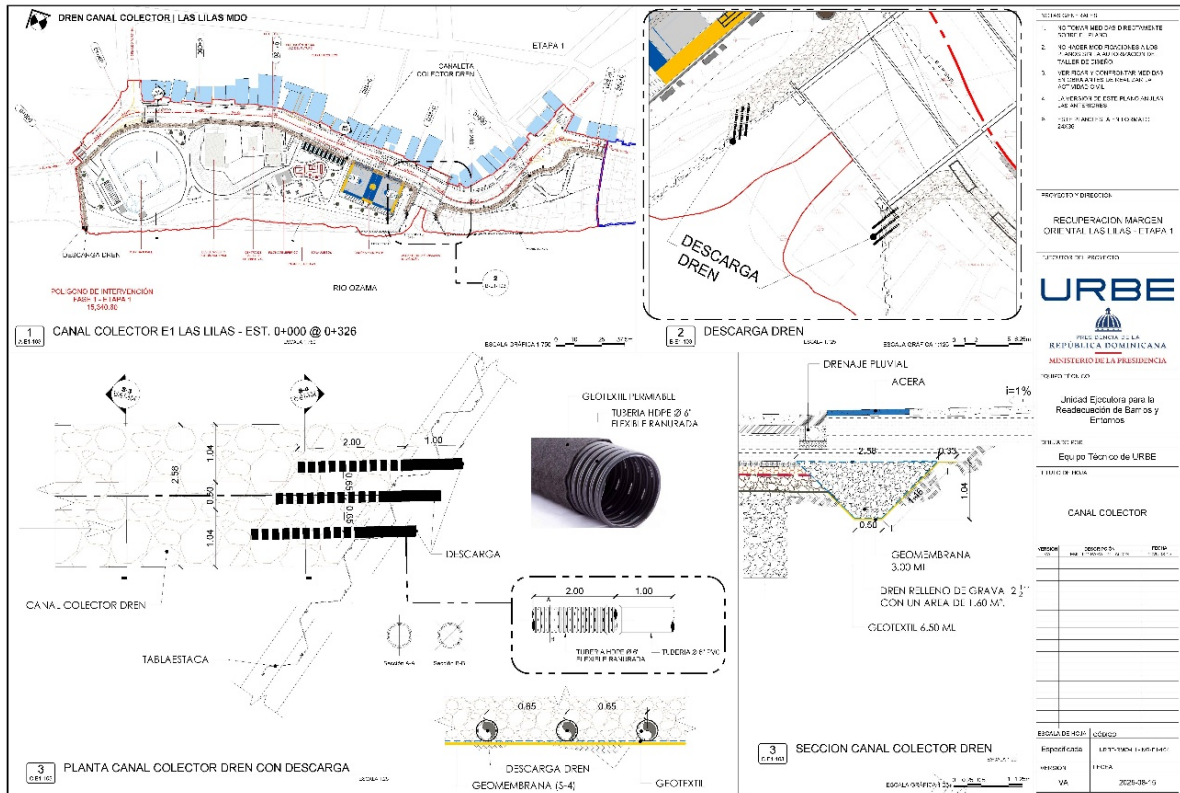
Detalle de canal colector propuesto en Las Lilas Etapa 01. Fuente: URBE, octubre 2025.
